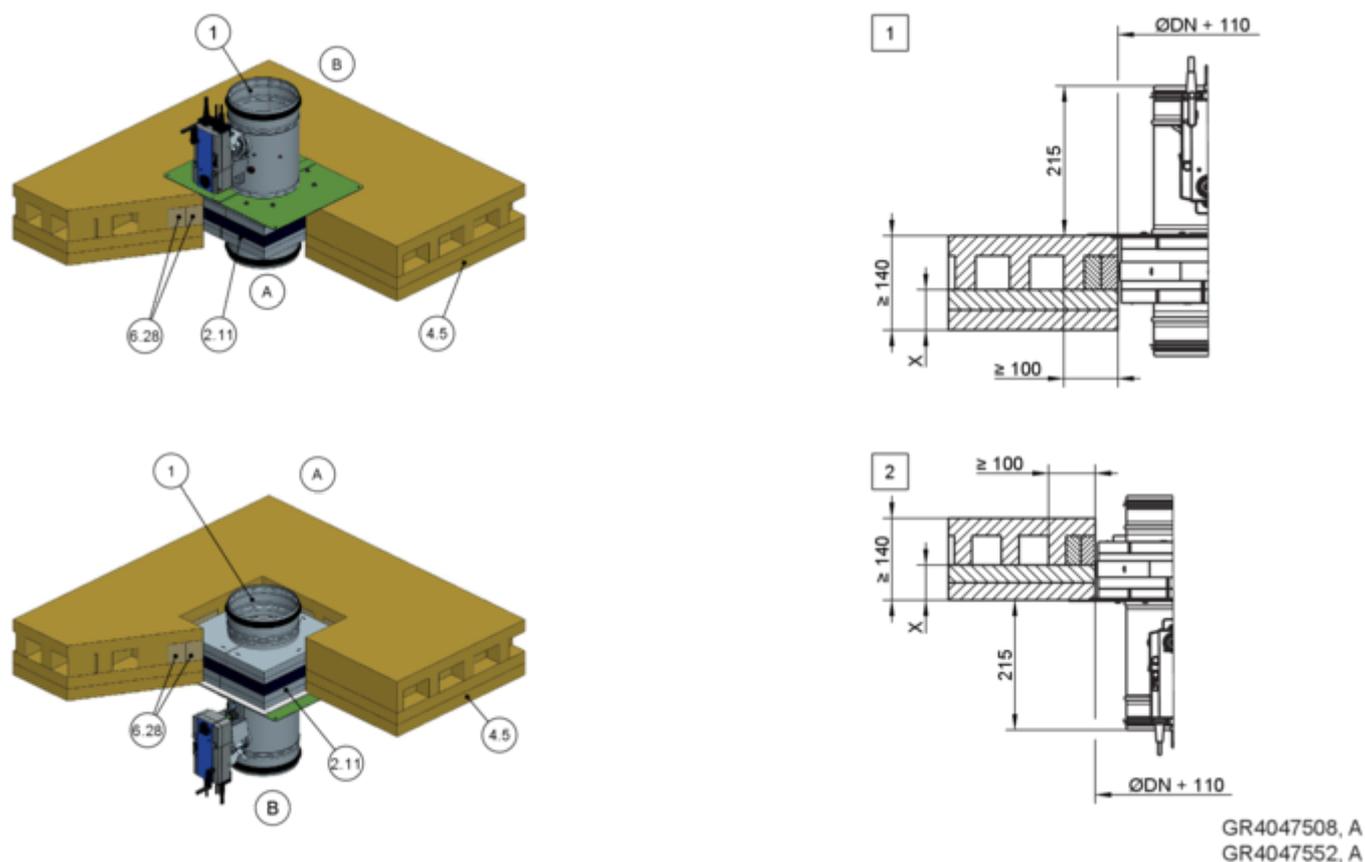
Montagem a seco sem argamassa em elemento de painel de madeira com kit de montagem TQ2, em pé e suspenso
